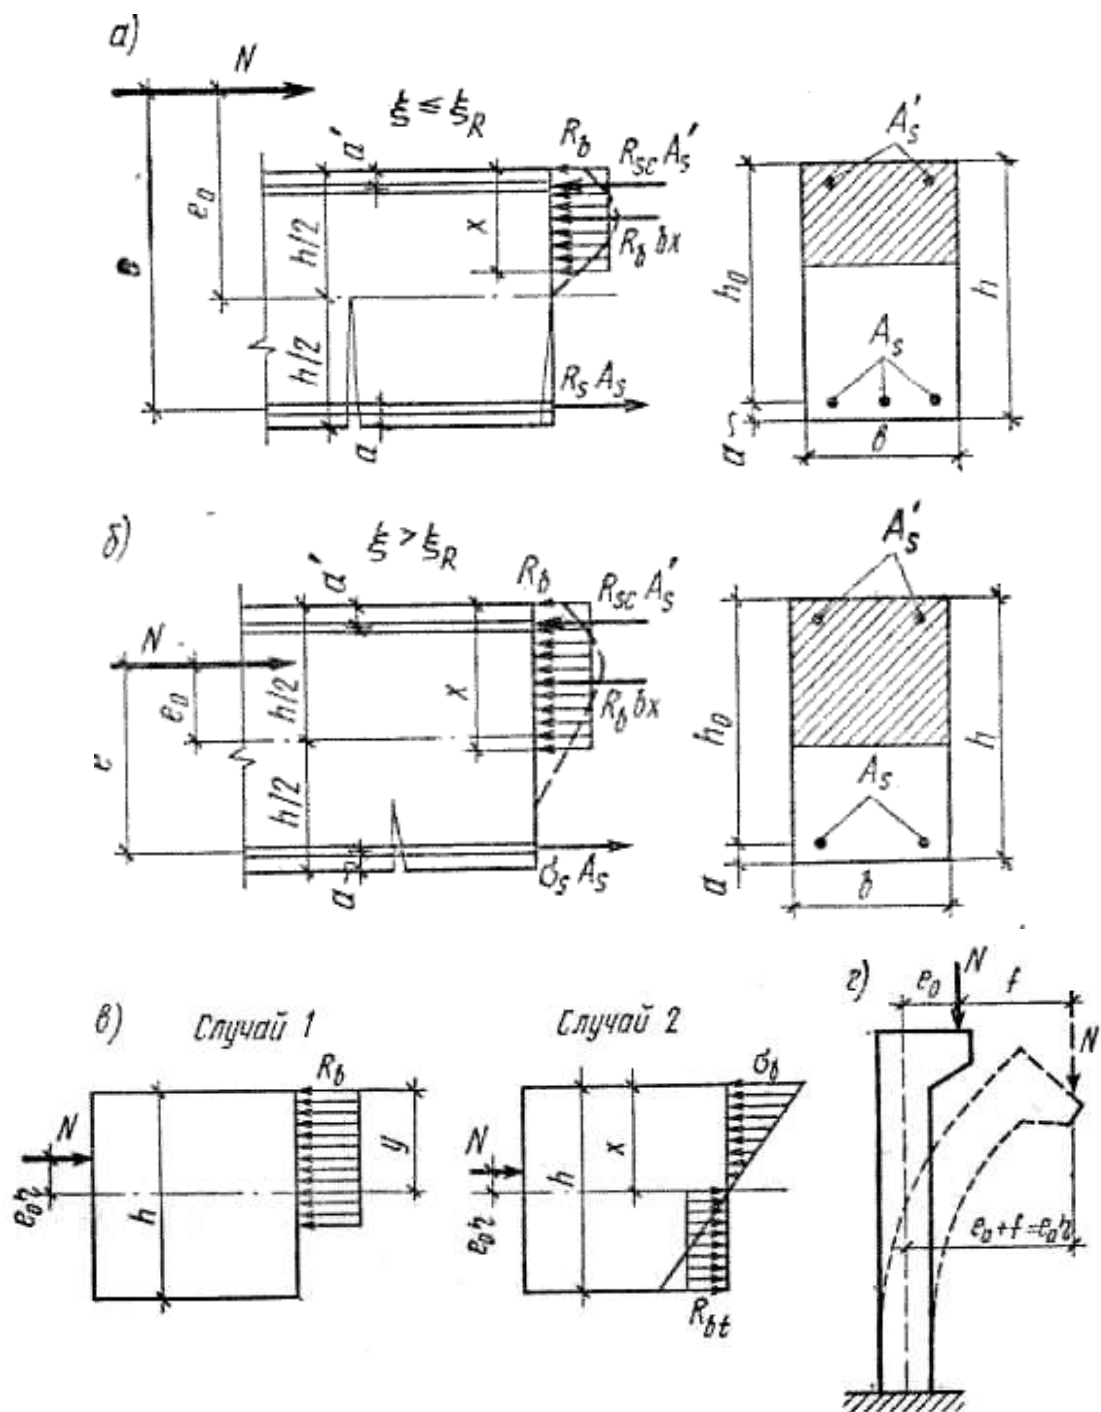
Схемы расчетных усилий в сечениях сжатых железобетонных (а, б) и бетонных (в) элементов; увеличение эксцентриситета продольной силы в гибких элементах (г)
